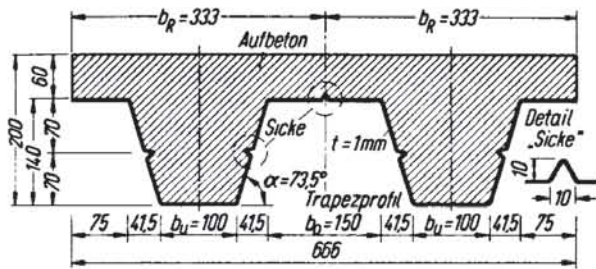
Ausbildung des Stahlprofils und der Stahlbetonrippenplatte
